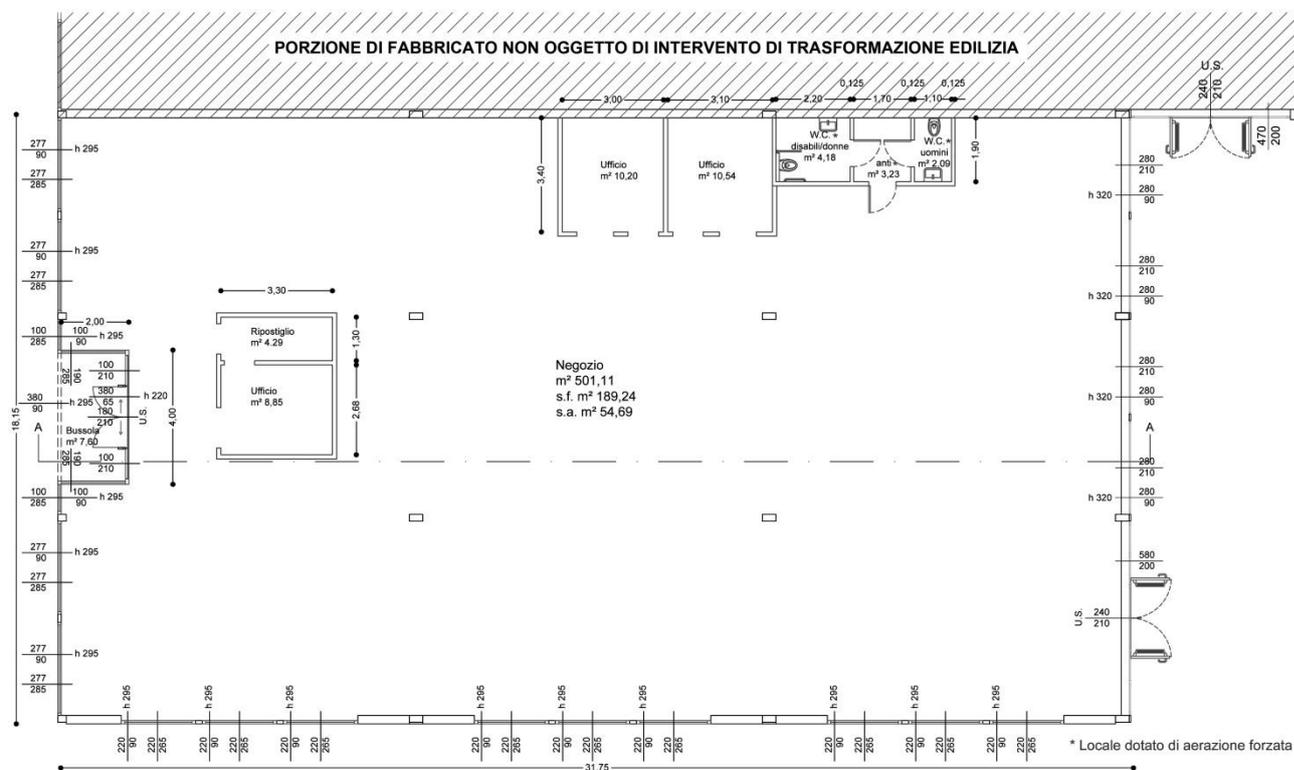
Pianta di progetto (Fonte: Progetto SCIA 04.05.2017).
